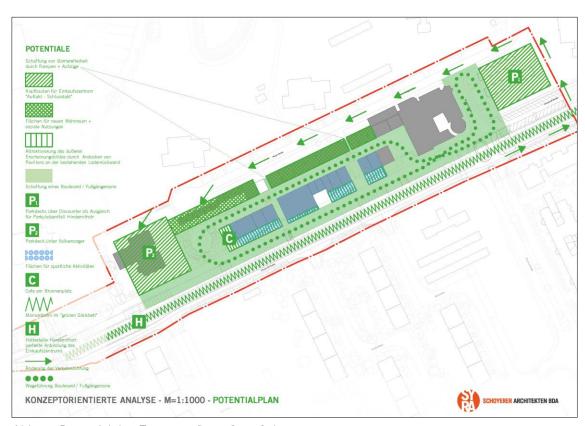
Potentialplan Zentrum, Büro Syra Schoyerer
